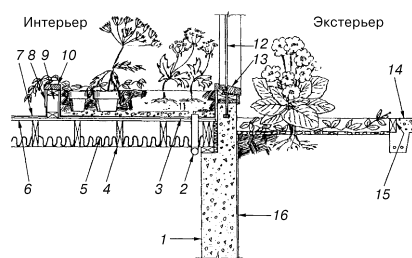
Наружный цветник, переходящий в зимний сад. 1 – бетонная стена (25 см); 2 – медная дренажная труба \varnothing 3,8 см; 3 – медный ящик для растений; 4 – доска 5×20 см; 5 – теплоизоляция; 6 – фанера; 7 – виниловые плитки пола; 8 – облицовка стены; 9 – стойка (5×10 см); 10 – нащельник деревянный; 11 – гравий; 12 – витраж; 13 – слив; 14 – бетонное покрытие; 15 – антисептированный брусок (5×10 см); 16 – гидроизоляция
